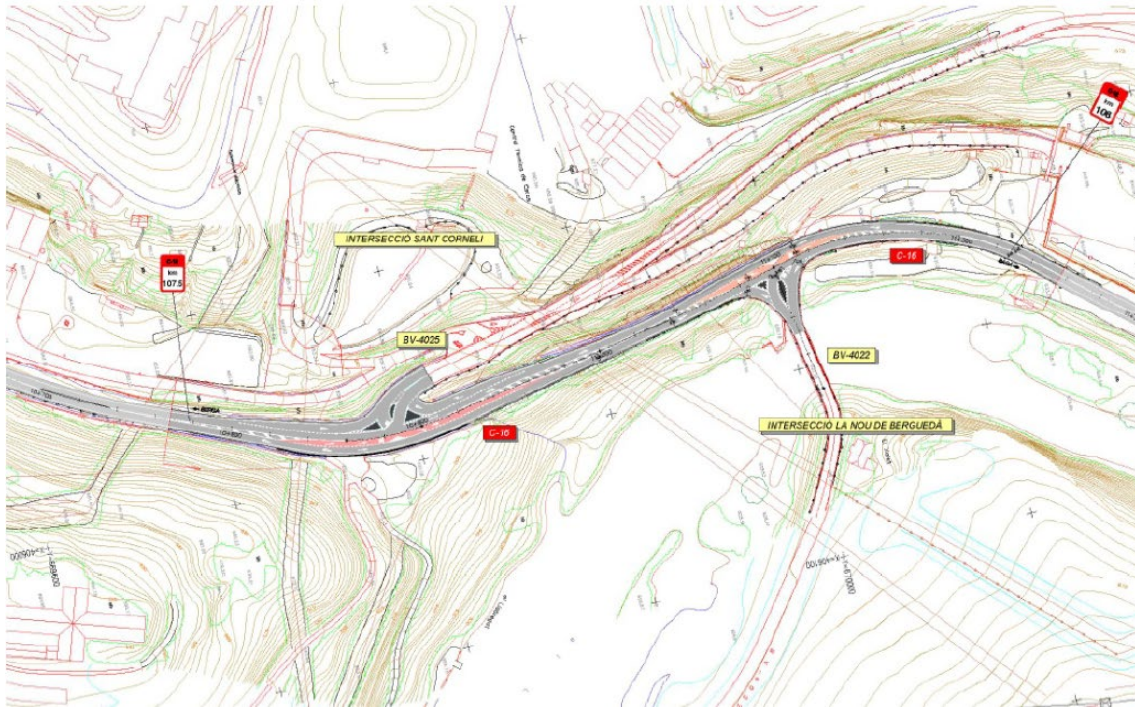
Planta general de les interseccions de la C-16 (Font: Memòria del Departament 2019).
